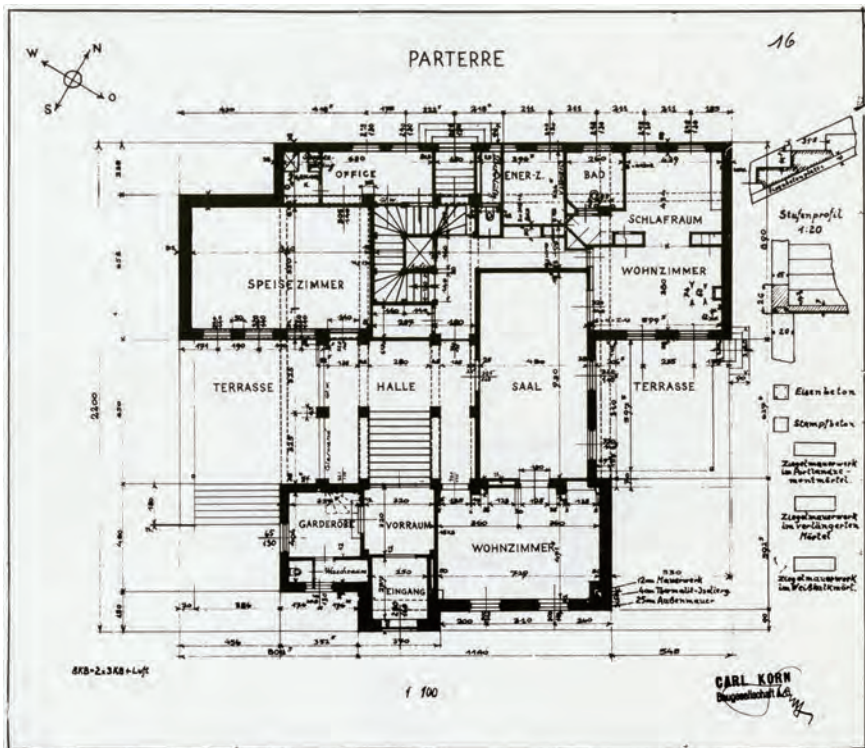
施工図面 (主階平面図)。施工業者カール・コーンが作成。(148 頁参照)
